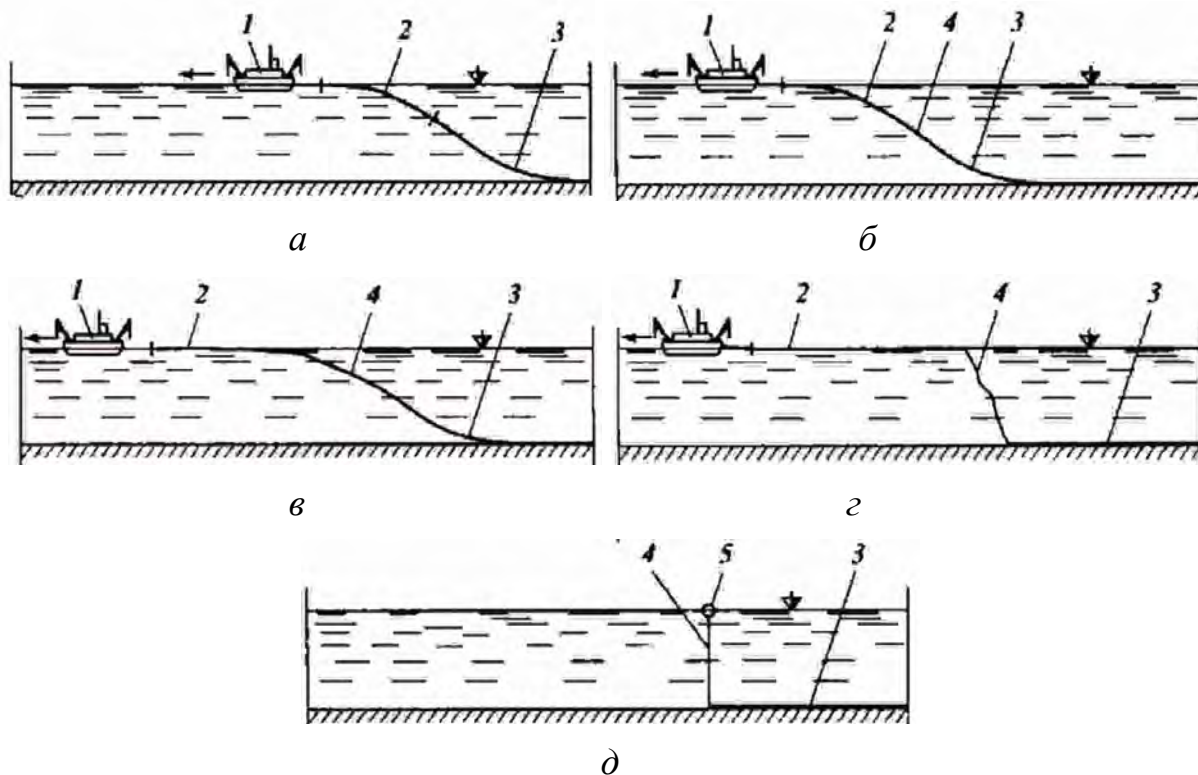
Схемы опускания трубопровода с баржи, оборудованной стрингером: а — начальная стадия укладки трубопровода; б — опускание трубопровода с помощью тягового троса; в — отсоединение укладываемого трубопровода от баржи; г — завершение укладки плети трубопровода на дно; д — фиксация тягового троса бумом на поверхности воды: 1 — трубоукладочная баржа; 2 — стрингер; 3 — трубопровод; 4 — тяговой трос; 5 — буй
